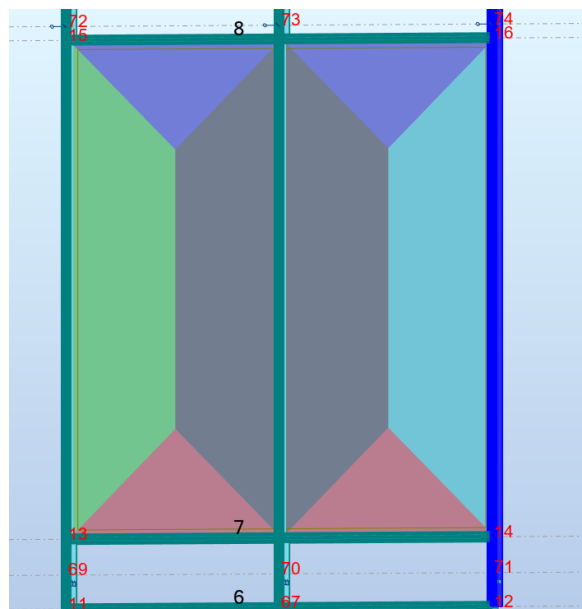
Transferência de esforços para os montantes e para as travessas de uma fachada “*Curtain Wall*”.
